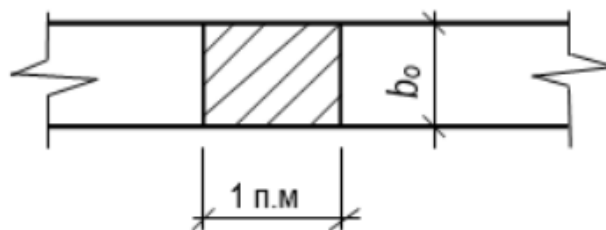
Площа підшви фундаменту для стрічкових фундаментів
